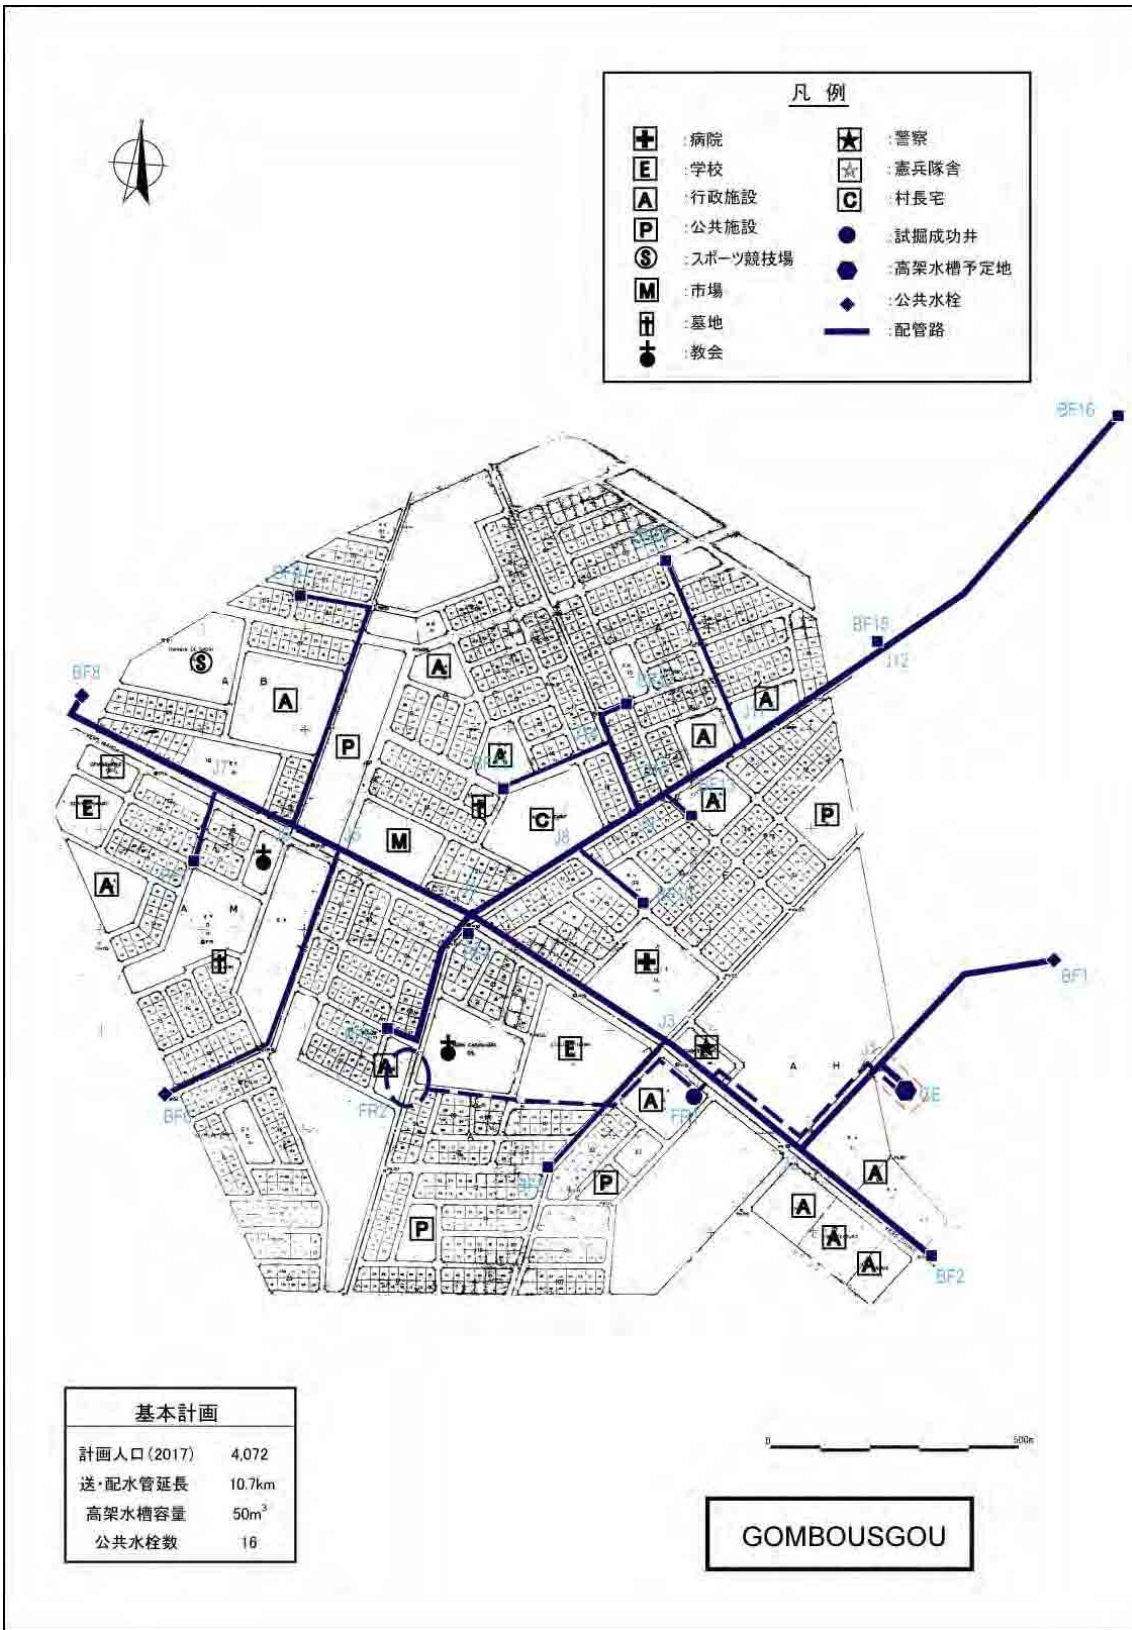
計画対象サイト(Gombousgou)の給水施設平面図
